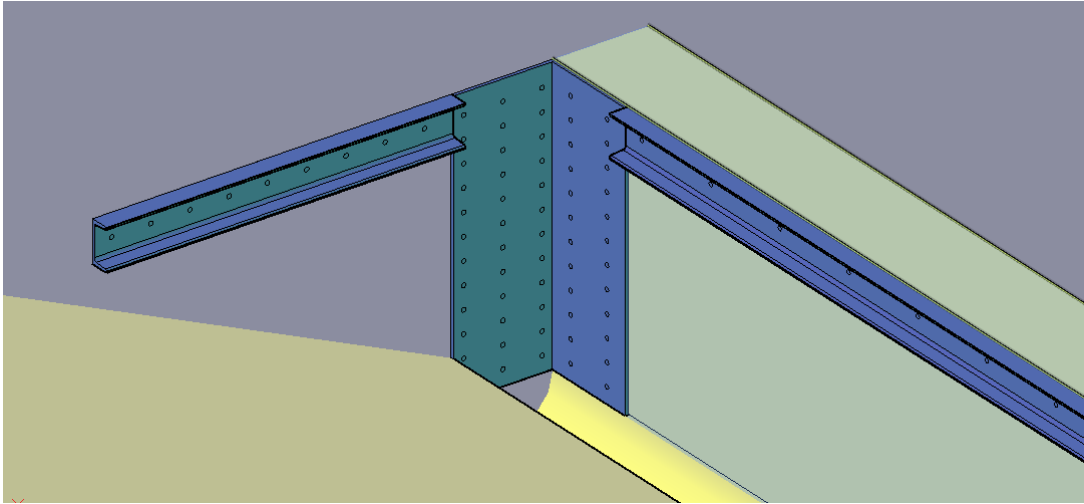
Disposizione dei tiranti sul prospetto Nord.
